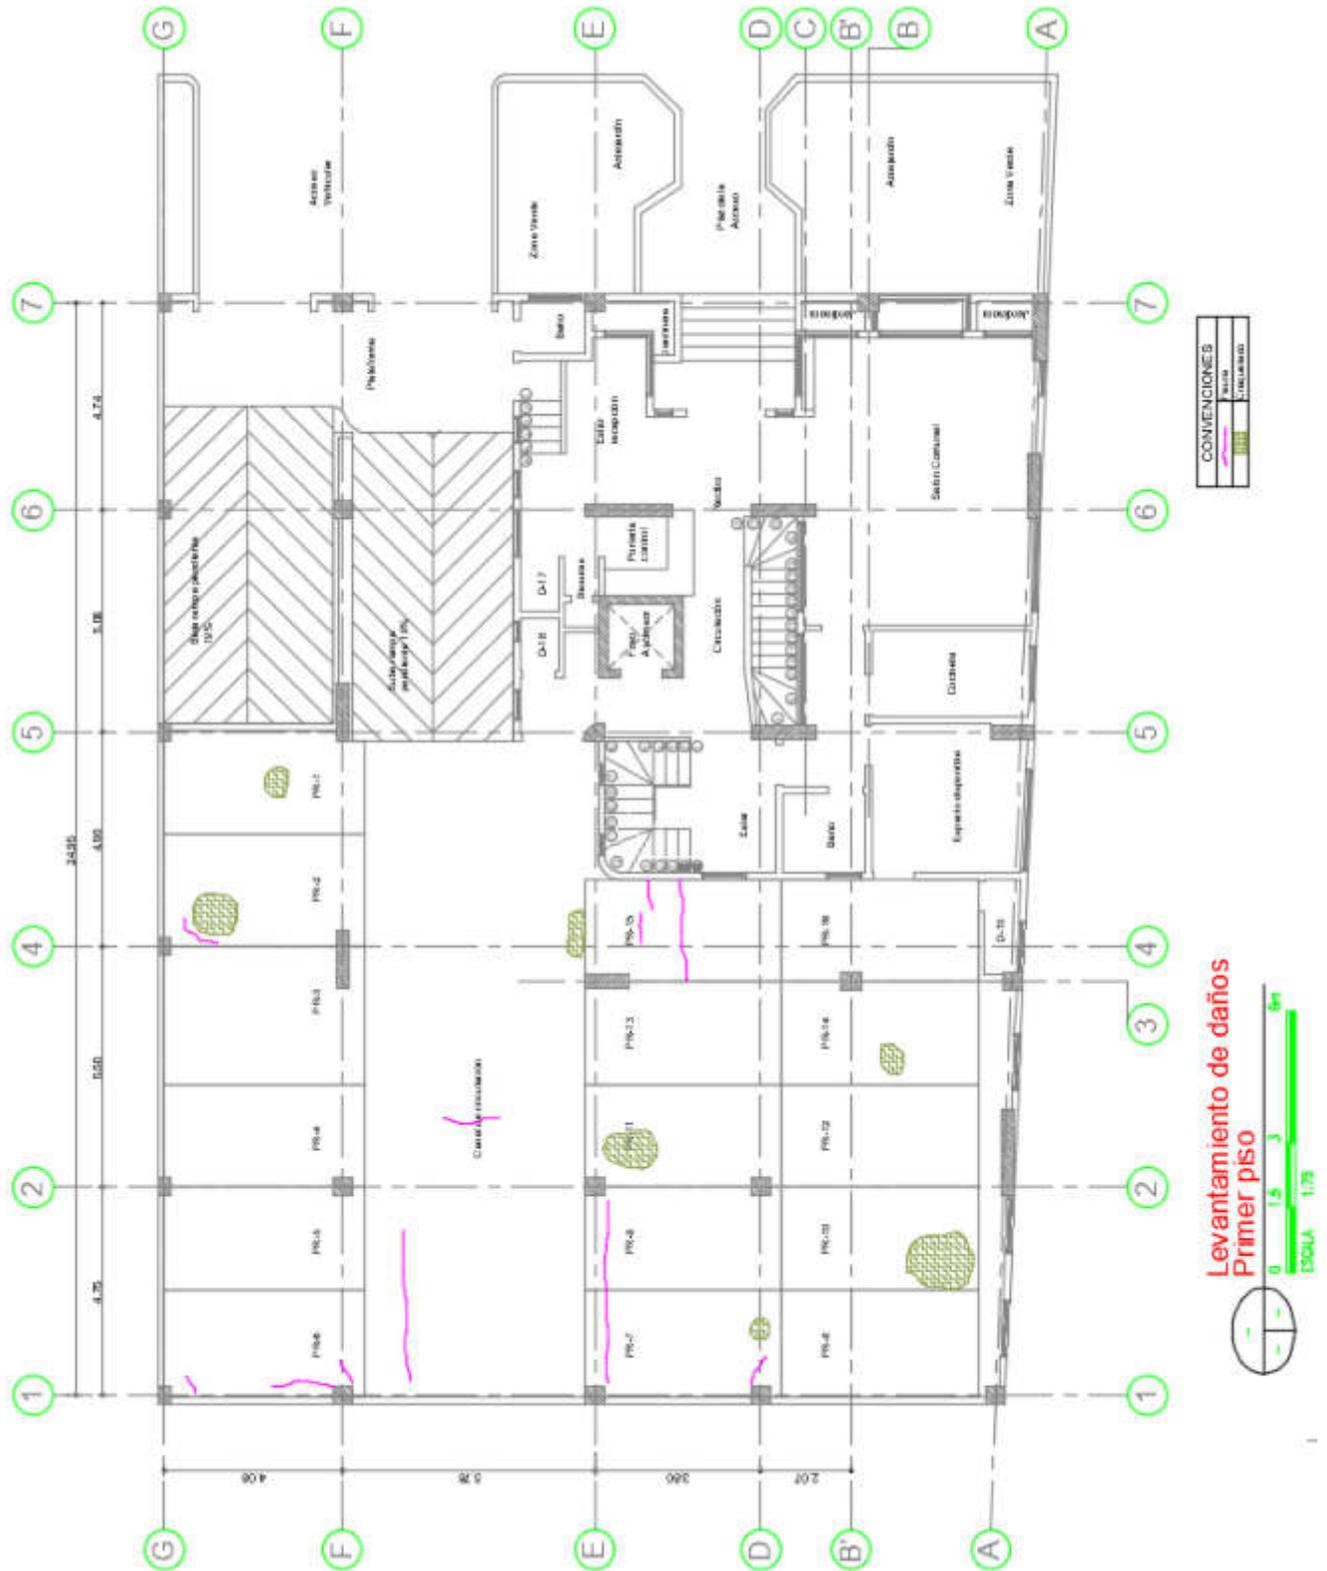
Levantamiento de daños en primer piso sobre la cara superior.
